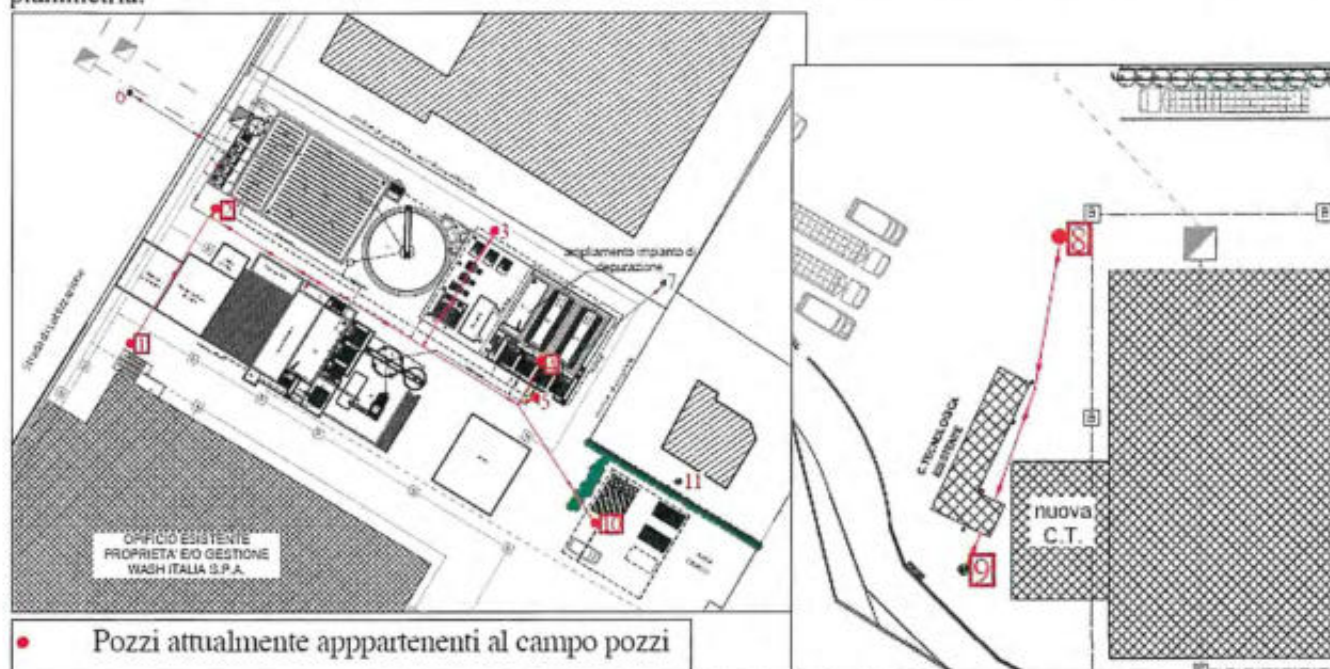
Planimetria ubicazione pozzi (da integrazioni allo SIA)
